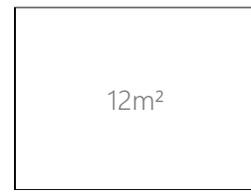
maximale Grundfläche, Grundriss, Maßstab 1:125
